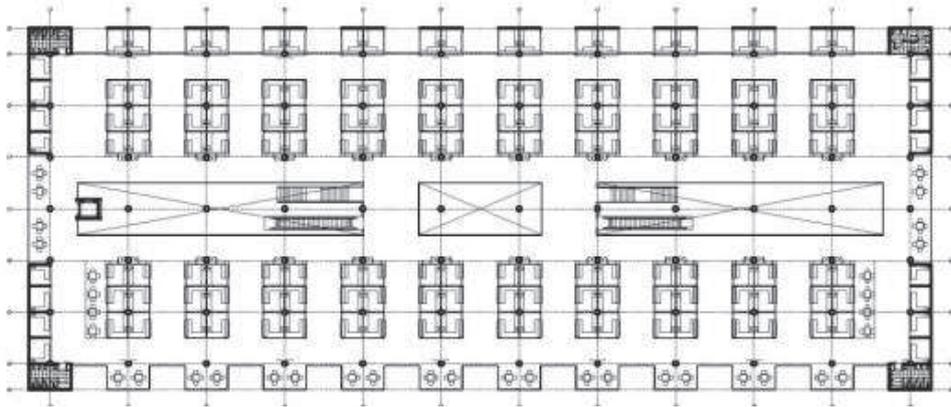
VISTA PLANTA DE PRIMER PISO
